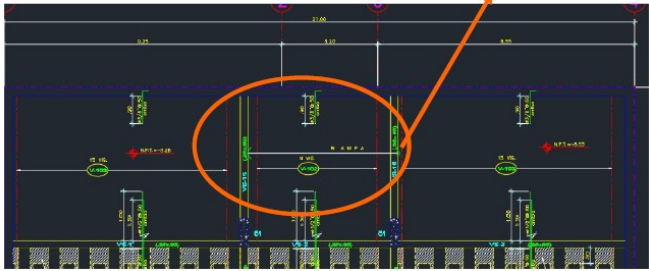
Detalle de incompatibilidad entre el plano de arquitectura y estructura en el detalle de la ubicación de la rampa.
